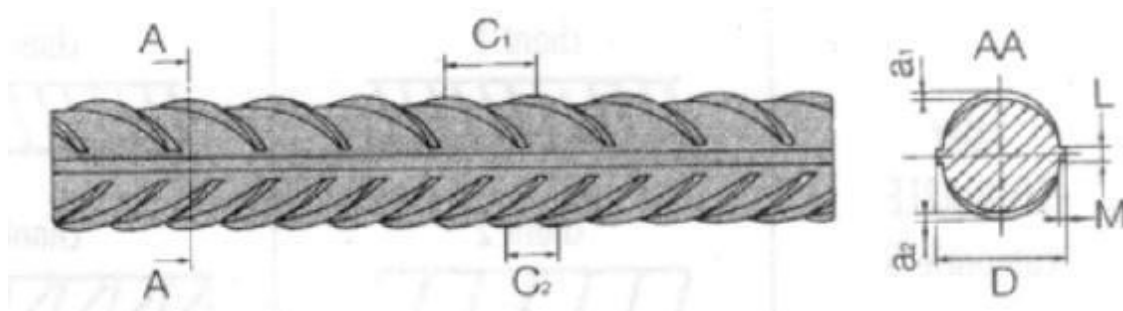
Vue de face et coupe transversal d'une barre HA
